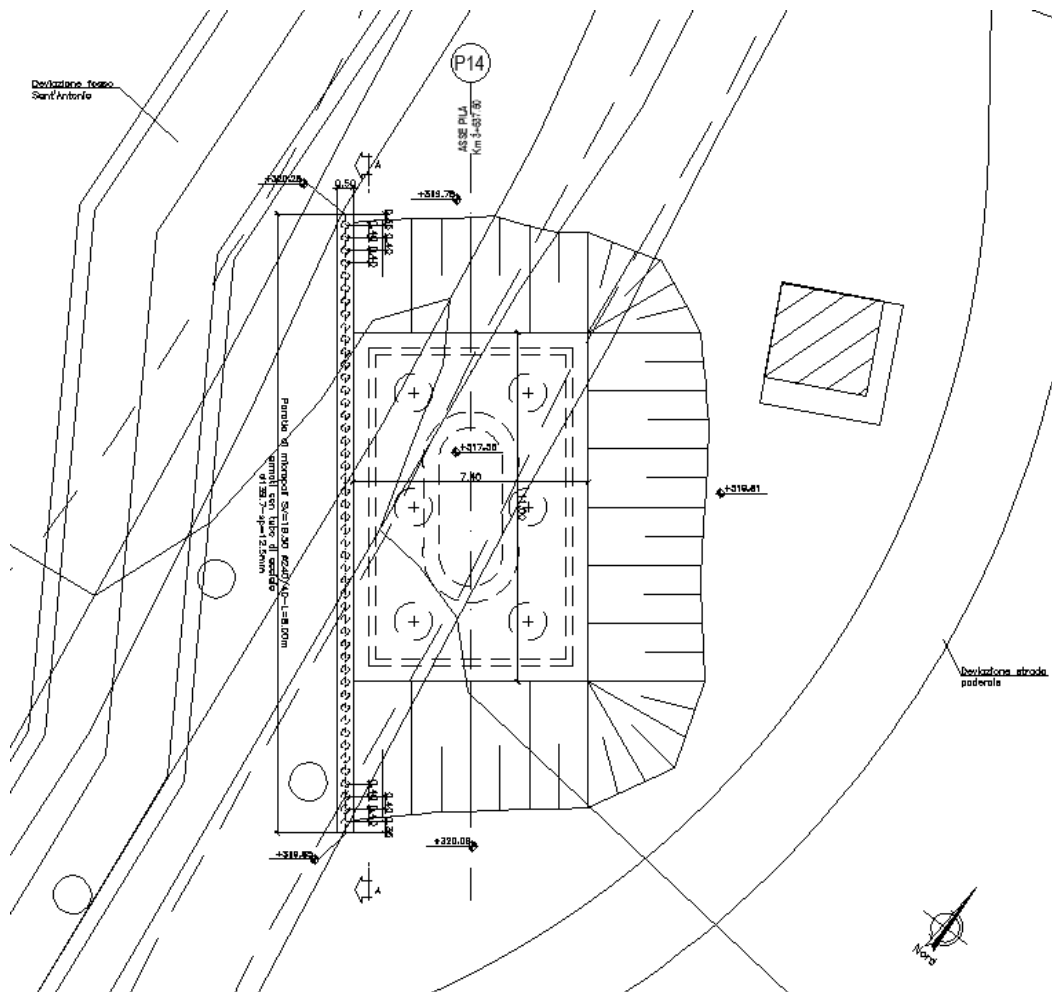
Planimetria dell'opera provvisoria Pila 14
